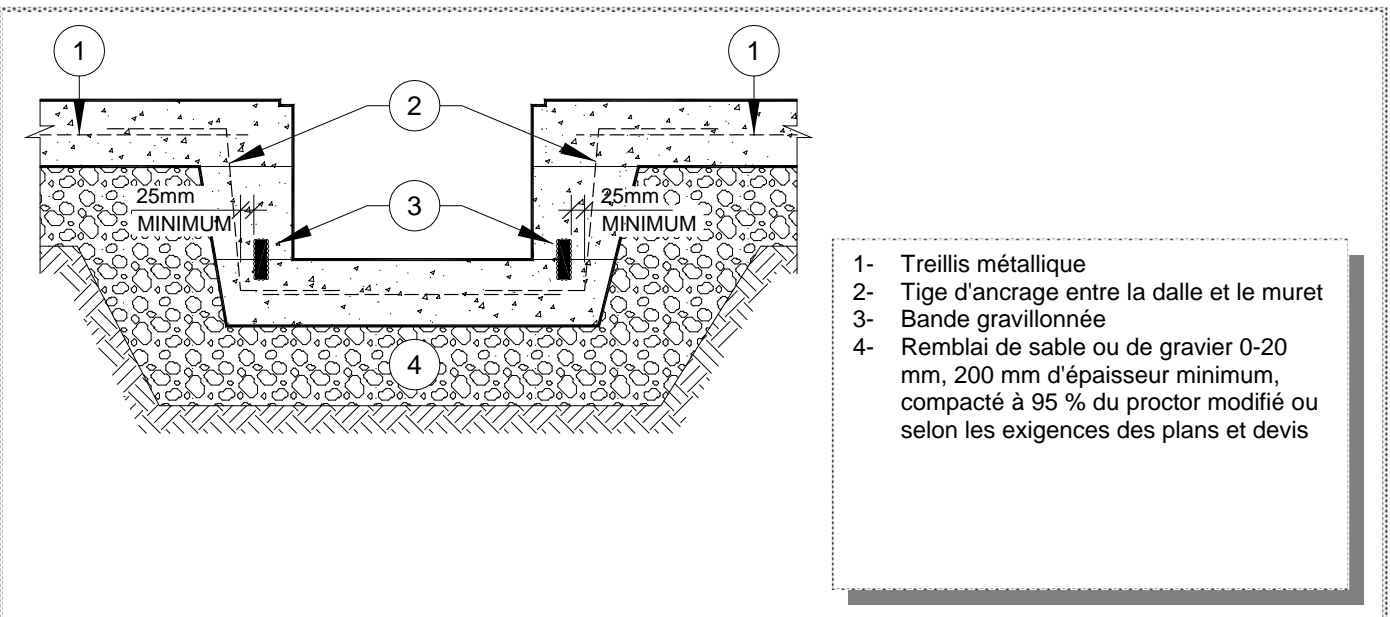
Étanchéité d'une rigole de nettoyage (Joint de construction)
